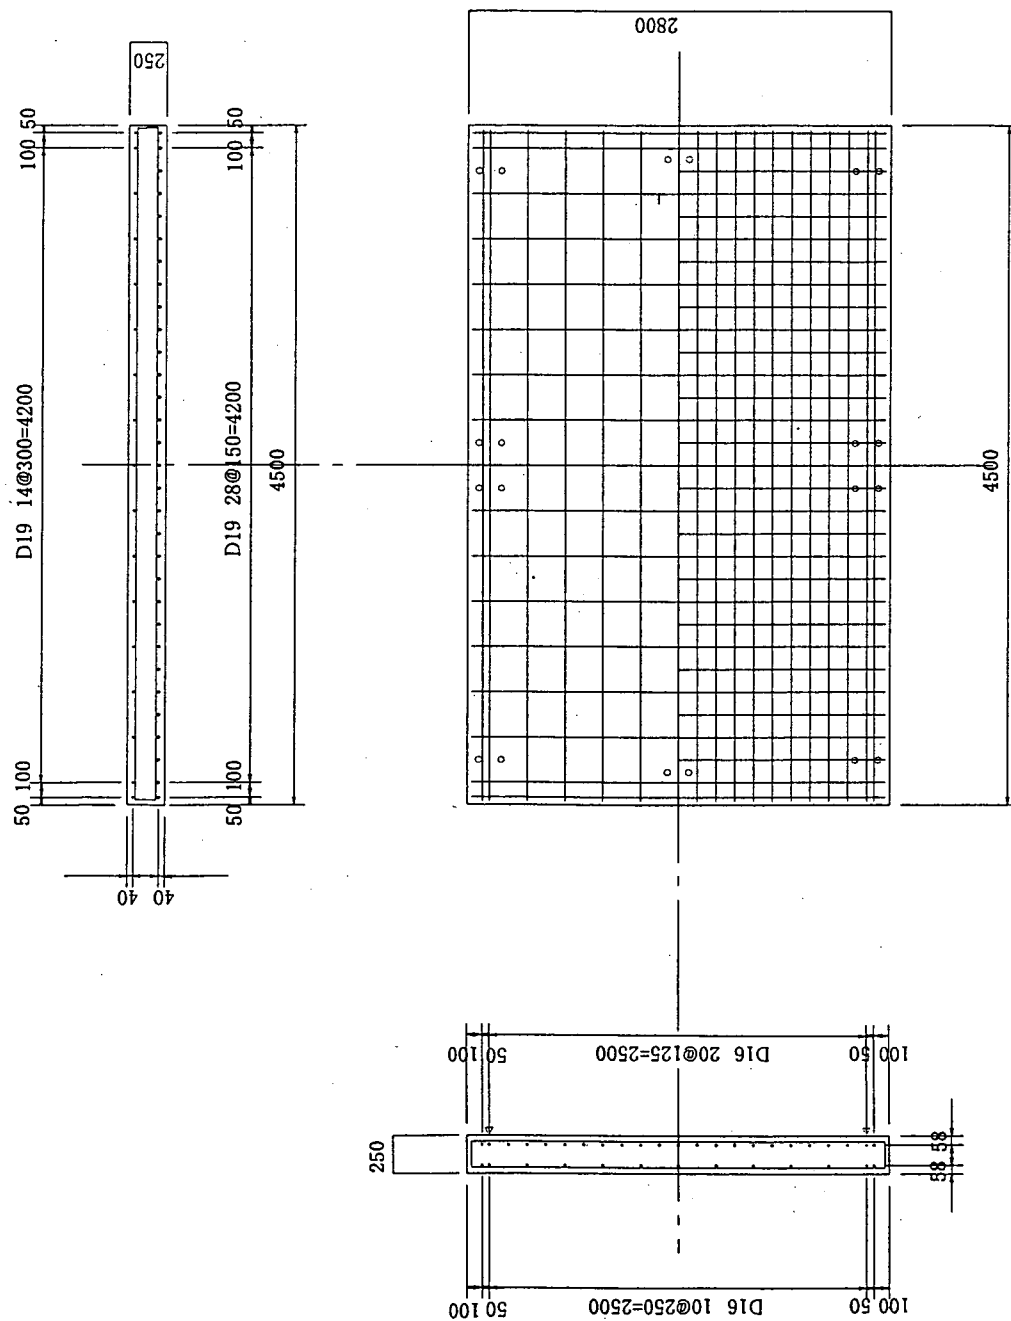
RC8n供試体の形状・寸法 (単位:mm)
